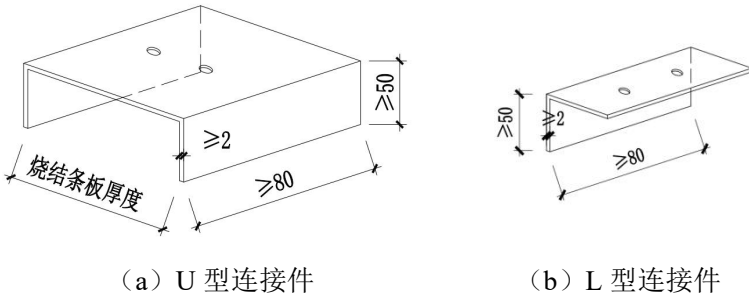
墙板与主体结构连接用的连接件构造示意
